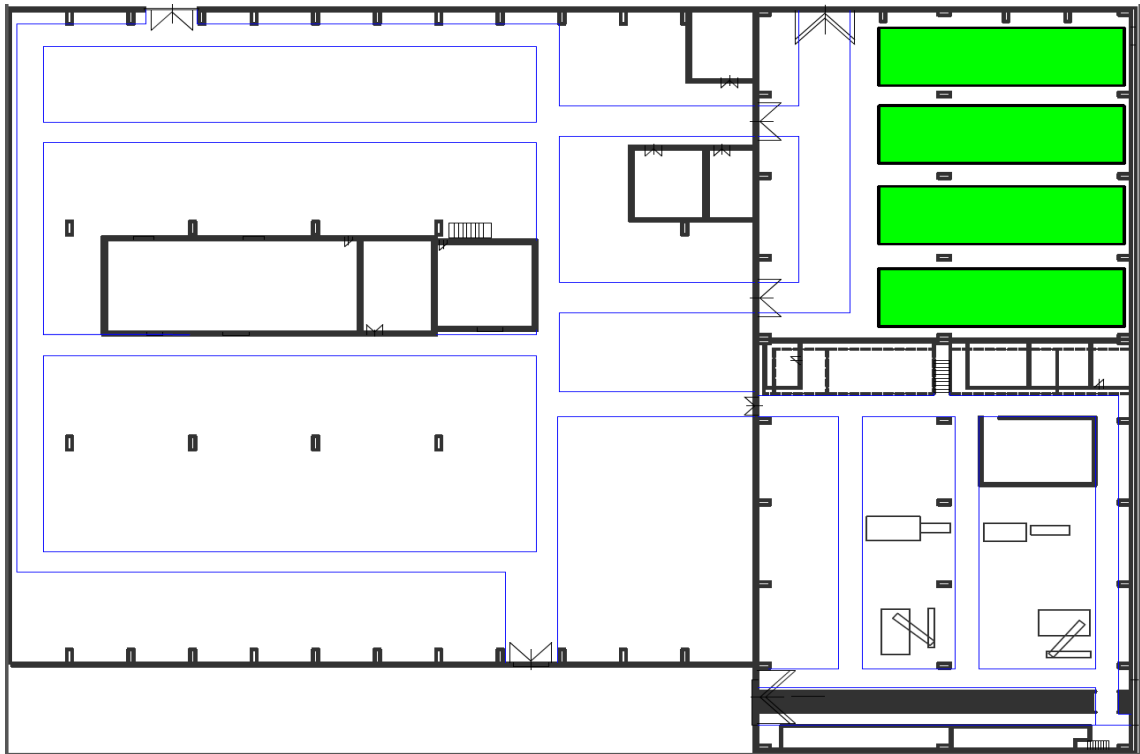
Původní provedení regálových zakladačů (zpracováno dle interních materiálů)
